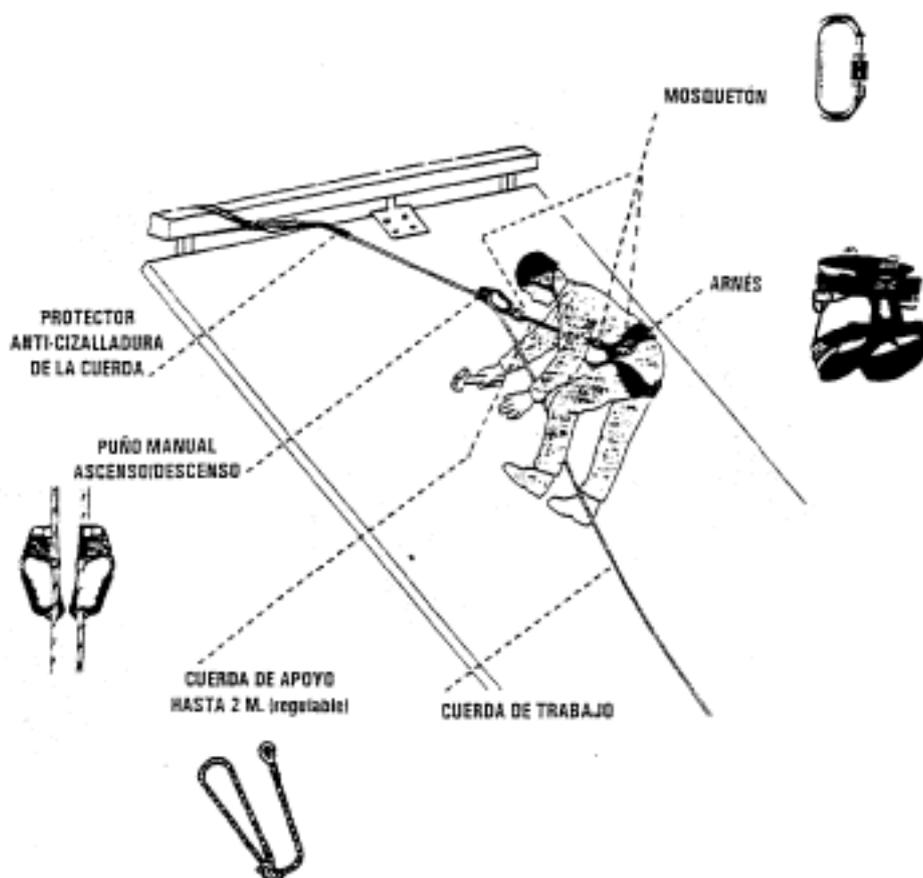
Detalle de cómo se debería trabajar en la ejecución de la cubierta.
